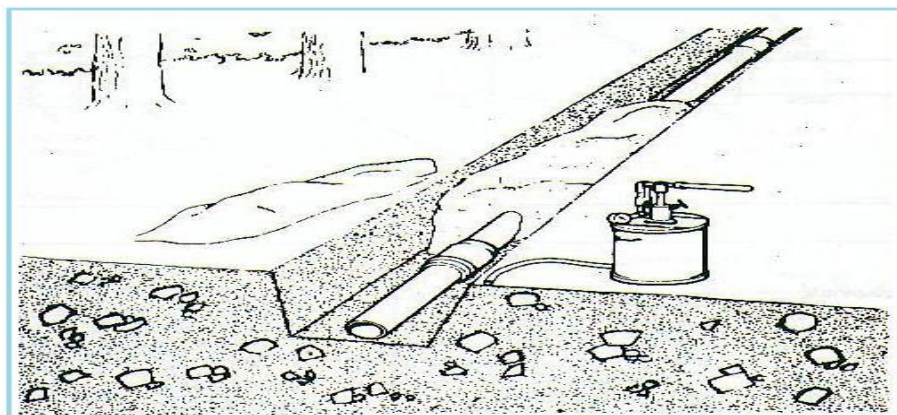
LES ESSAIS D'ETANCHEITE POUR LES CONDUITES ET LES JOINTS
